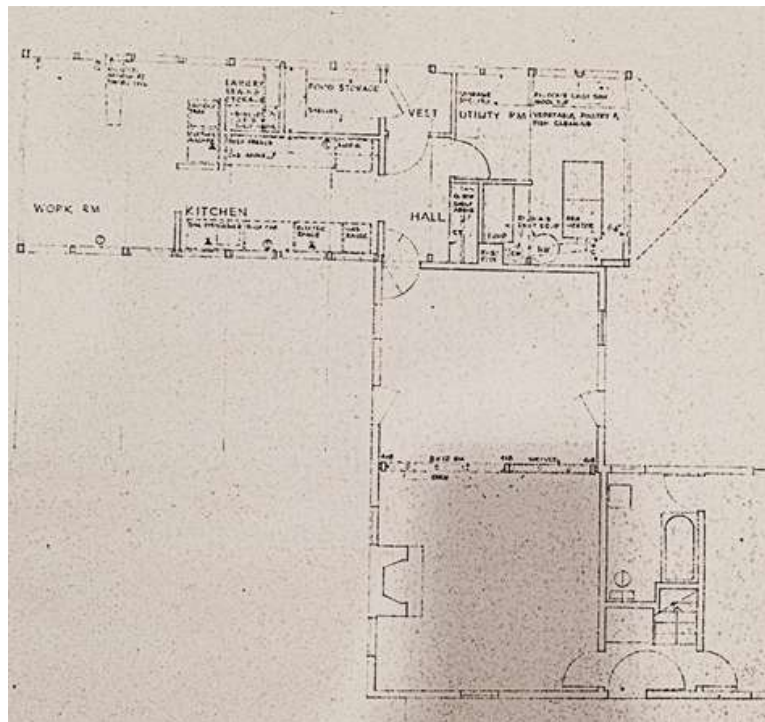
Detalle planta de la segunda propuesta de la adición de la casa Walworth Tyng.
